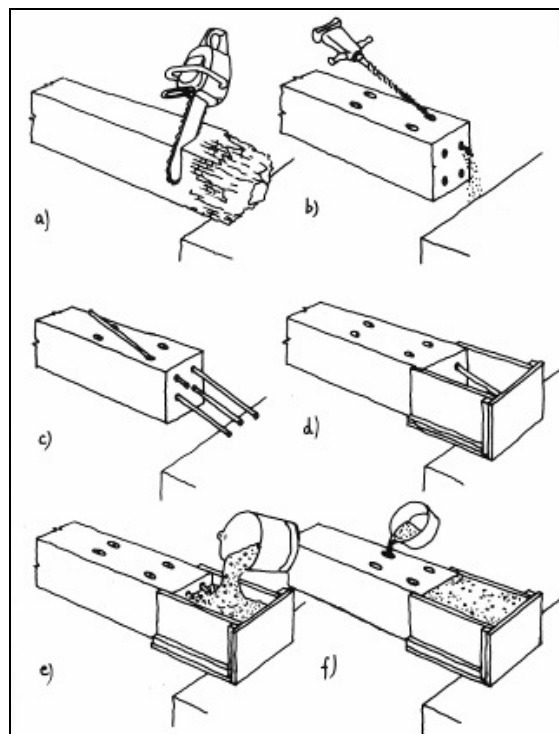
Sistema Beta, de refuerzo de apoyos en elementos de madera.
